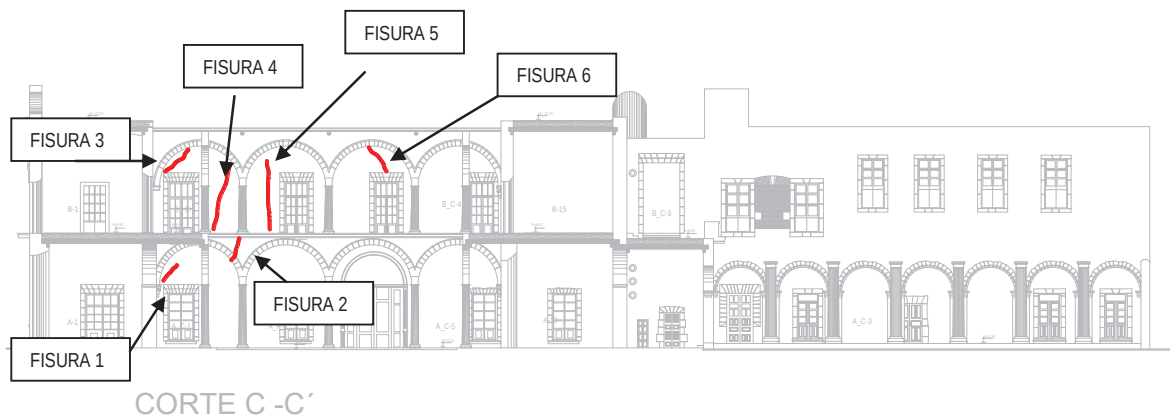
fisuras en los muros del corredor oriente, primer patio. (Levantamiento por: José Antonio Morales A.)
